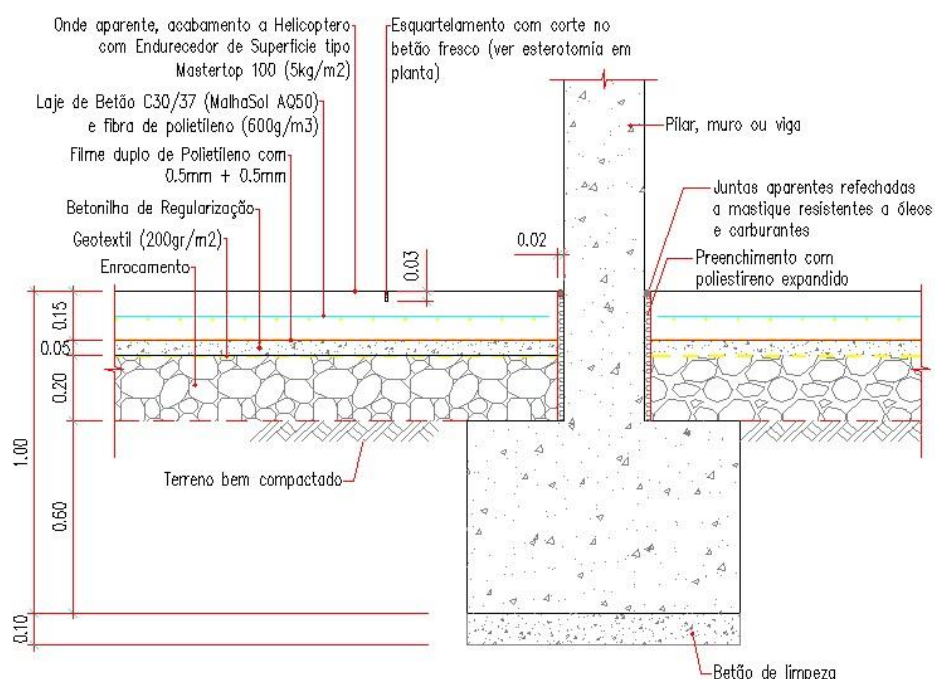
Pormenor da sapata e do pavimento térreo – solução adotada
